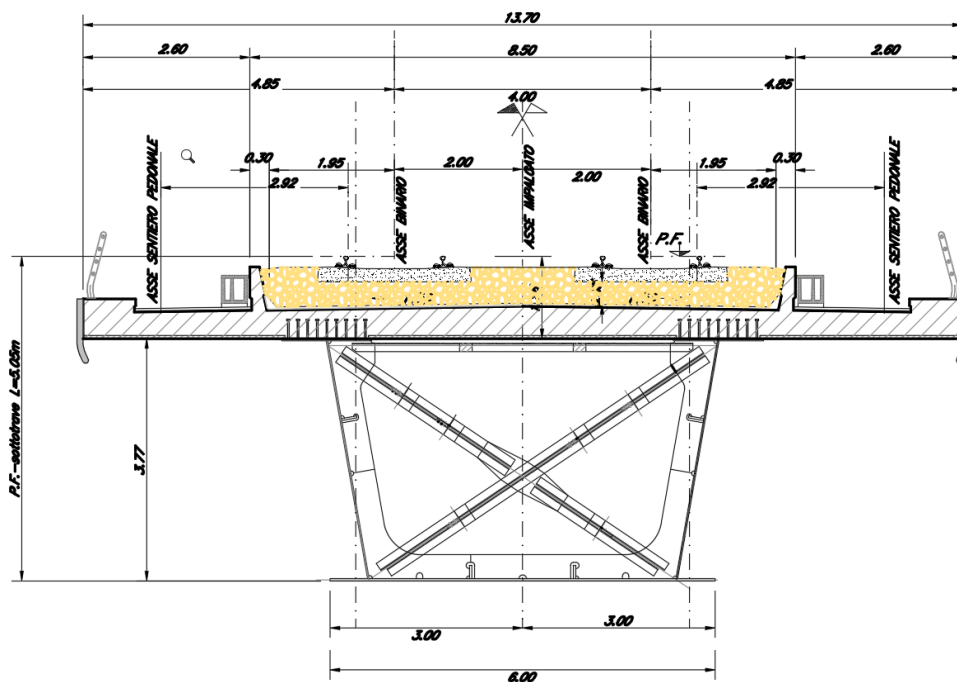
sezione trasversale impalcato tipo in acciaio 50m doppio binario
